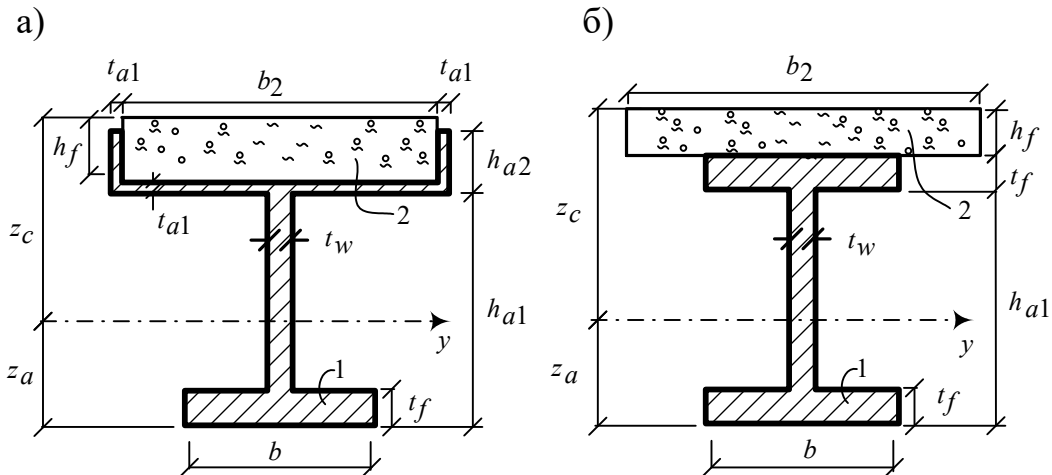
Поперечний переріз сталезалізобетонної балки у вигляді: а) тонкостінного «корита» з бетонною плитою; б) прокатного профілю (1) з залізобетонною плитою (2)
